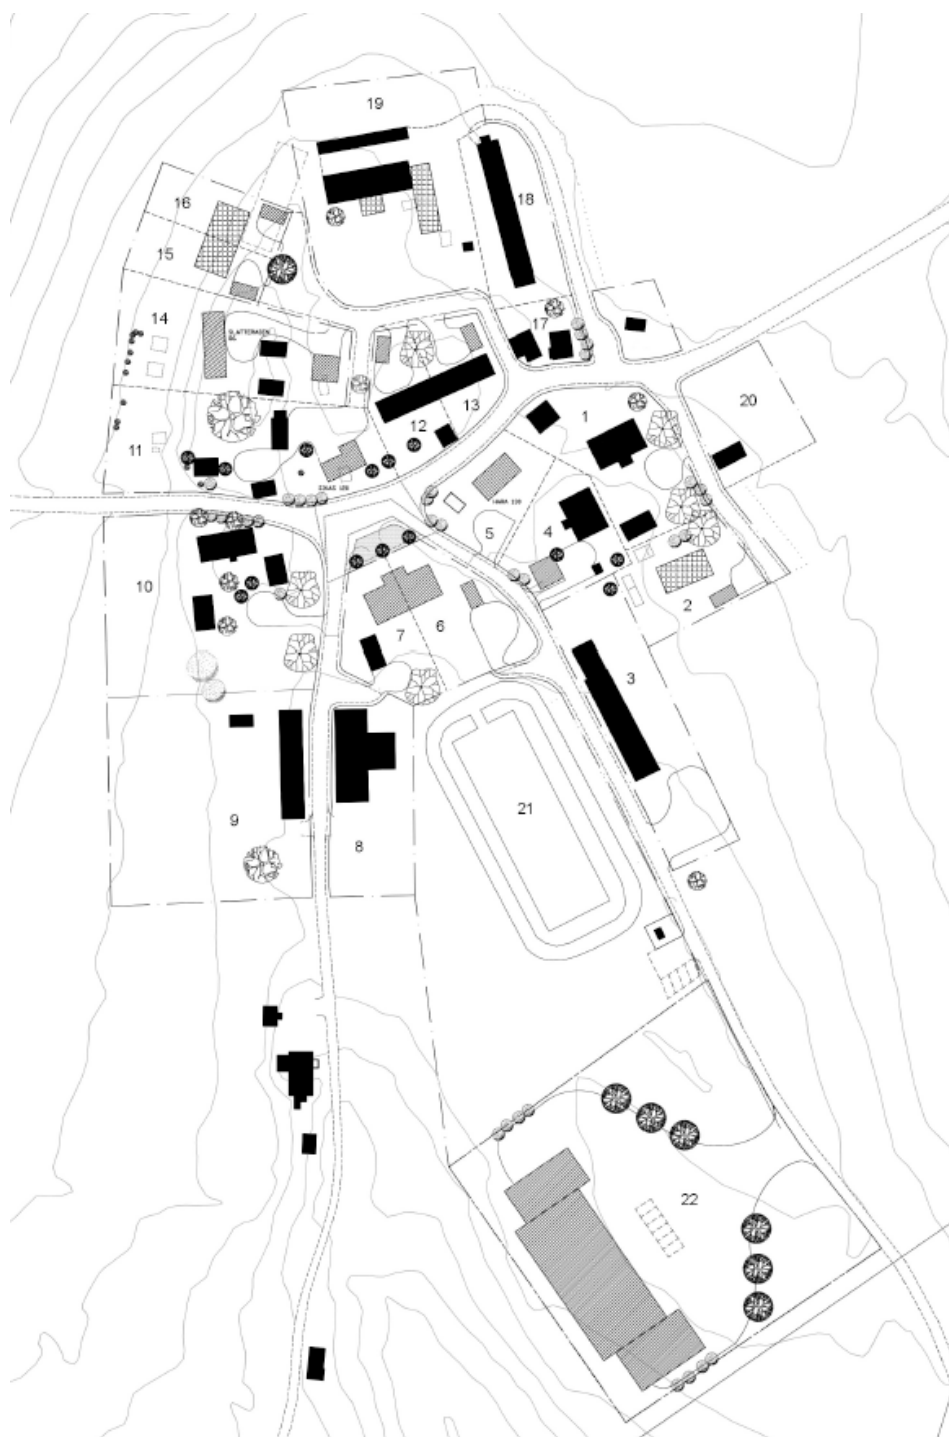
Illustrationsplan med förslag för Näs by. Befintliga byggnader är svarta och planerade byggnader är grå.
